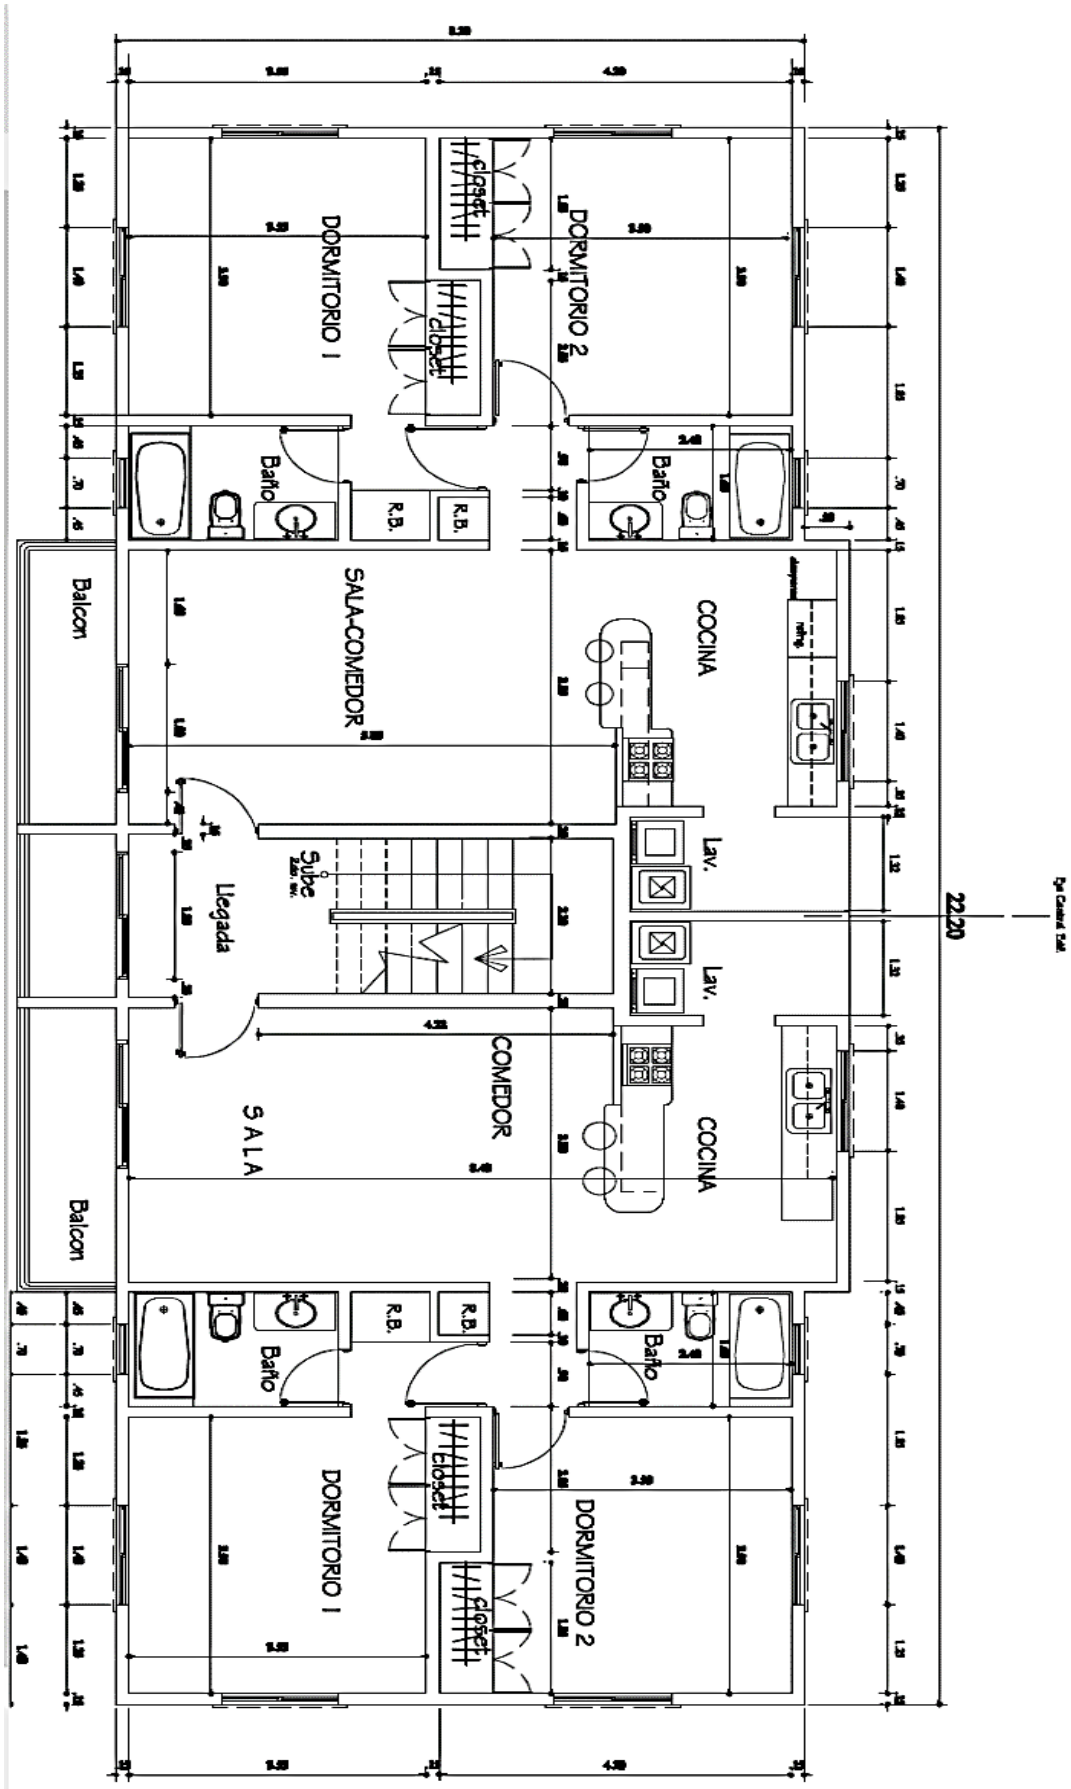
Planta arquitectónica dimensionada del 1er piso del edificio modelo
